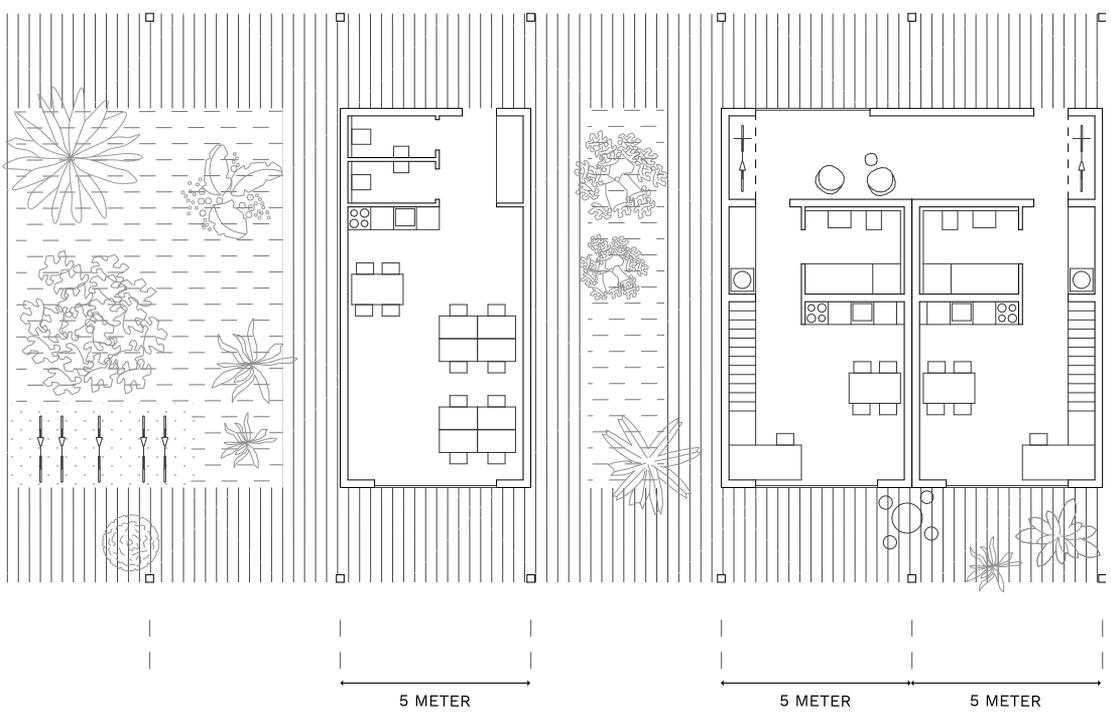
Grundriss der modularen Einheiten - Maßstab 1:200, Quelle: ED
